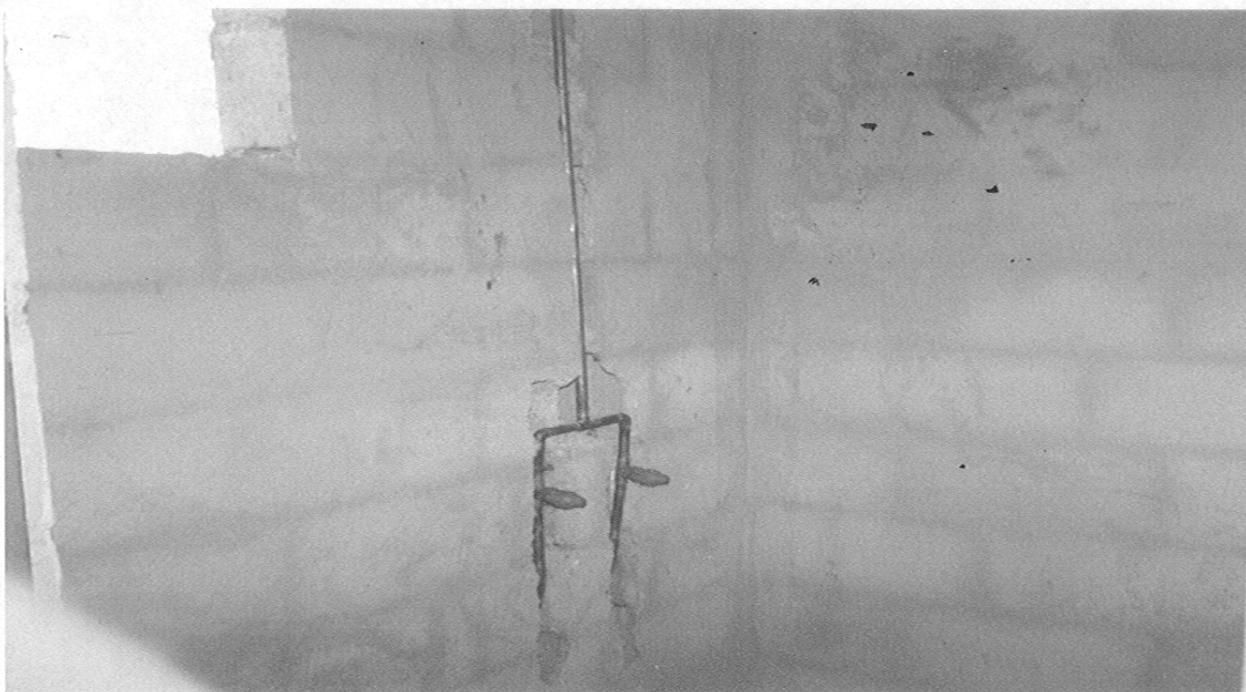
(1).- Muestra una de las instalaciones que se realizan en la losa de cimentación, instalación sanitaria.
